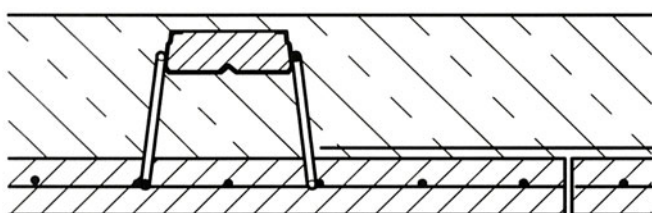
Oberkante Betongurt = Oberkante Ortbeton
